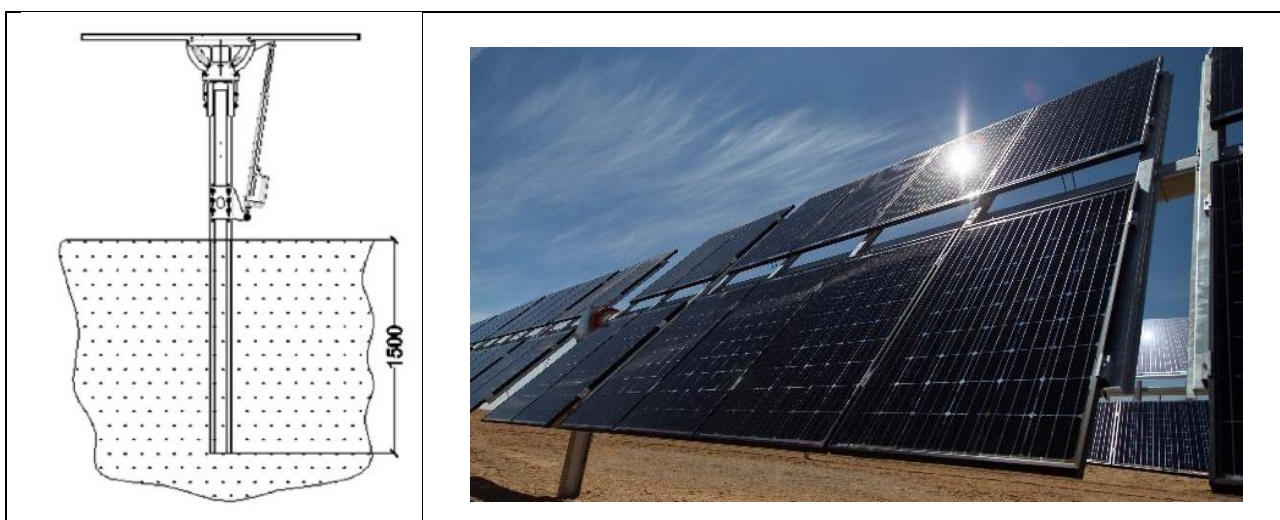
Tracker particolari - Pilo infisso nel terreno mediante macchina battipilo
